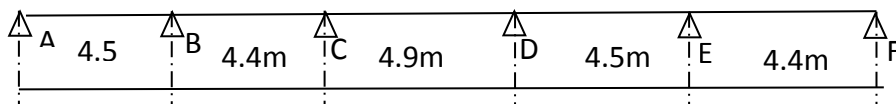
schéma statique de poutrelle étage bureau type 3
